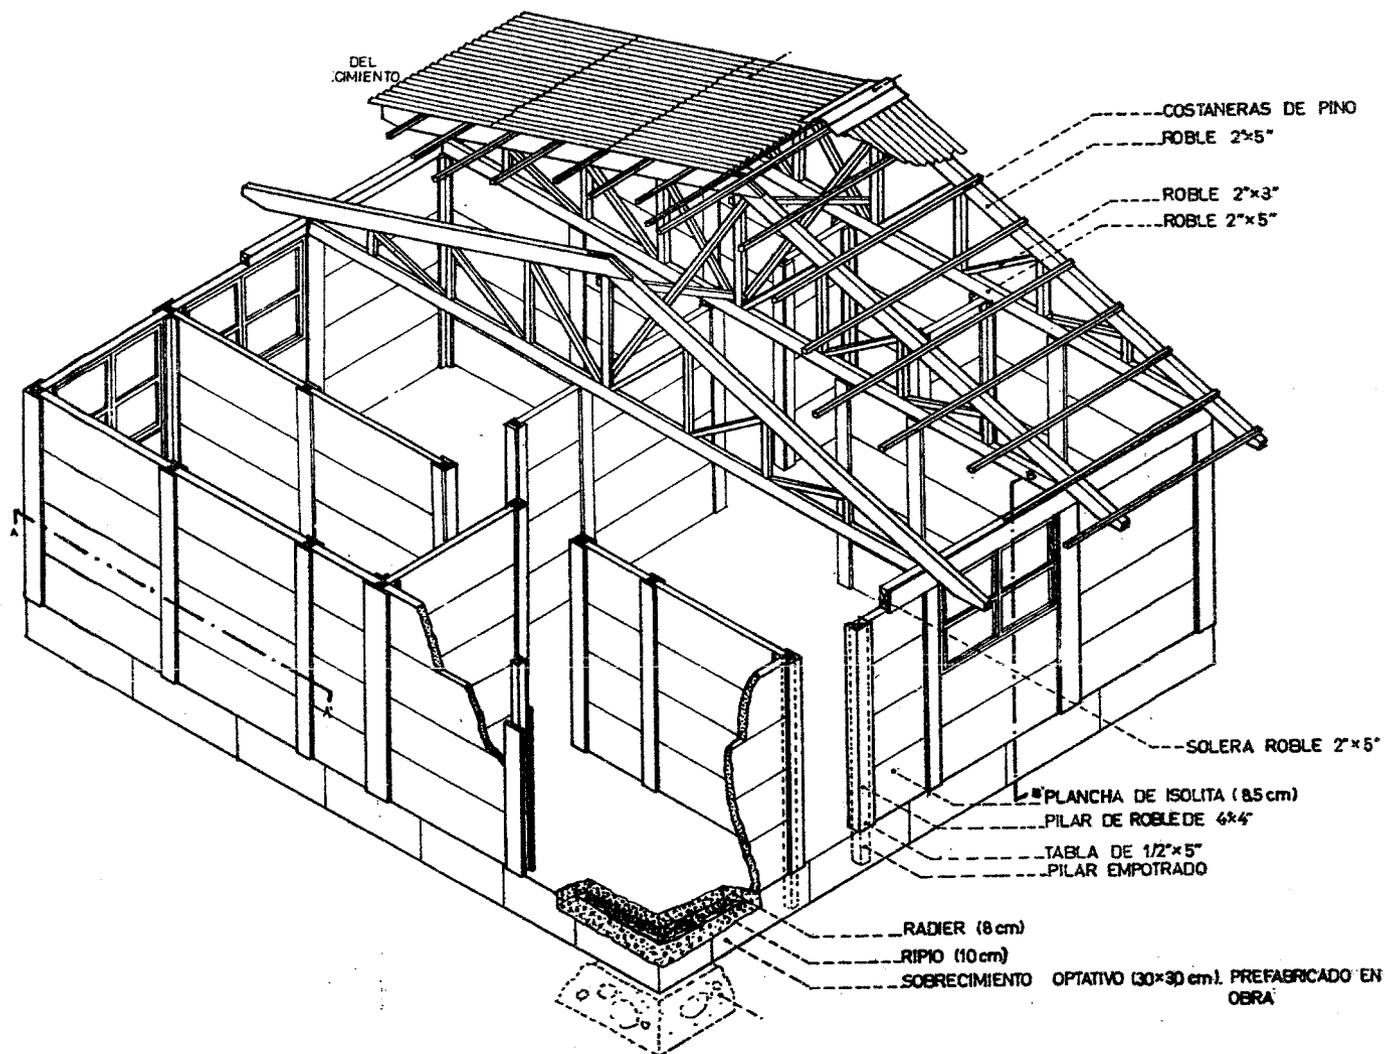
Casa ISOLITA. Sistema de prefabricación parcial cuyos muros están formados por una estructura de pies derechos de madera y planchas de ISOLITA entre ellas.
